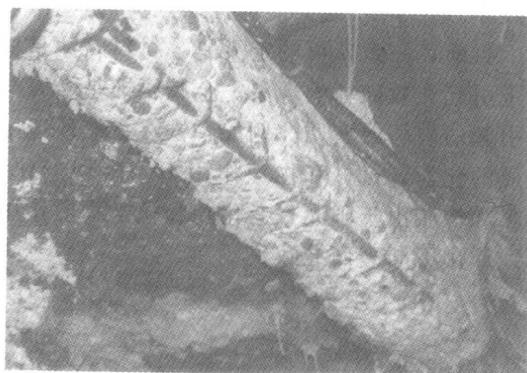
尿素厂房钢筋混凝土梁的腐蚀
